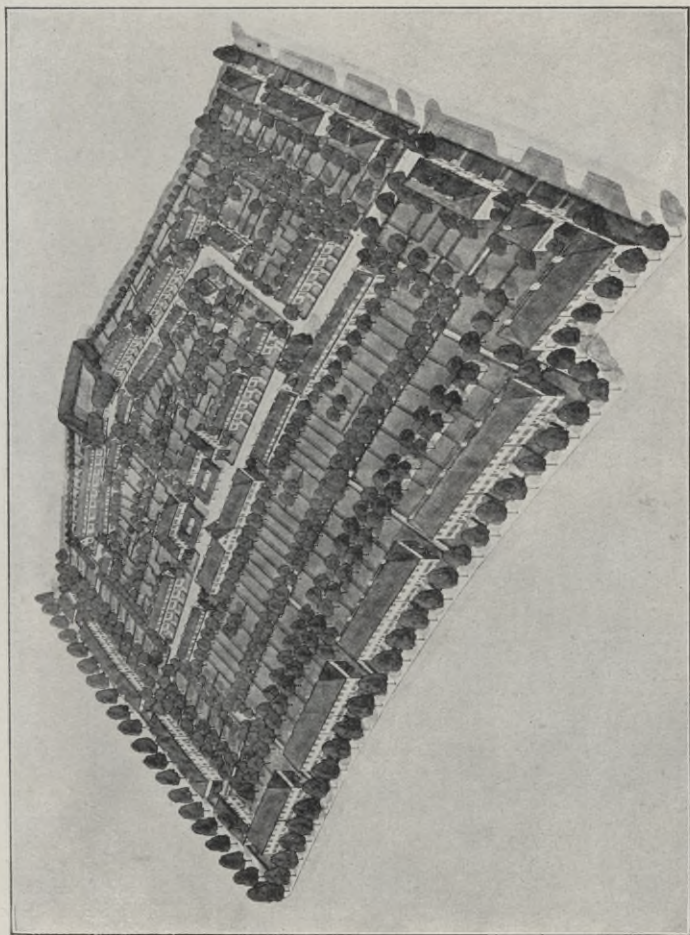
Flieget-Schaubild zu Abb. 19. Aufteilung eines Geländes für Kleinhäuser nach Gruppensystem bei Fünftelbebauung. (Zu Grunde liegt das Anwesen Fig. 70 a. Der Rand ist mit Zweiwohnungshäusern bebaut.)
